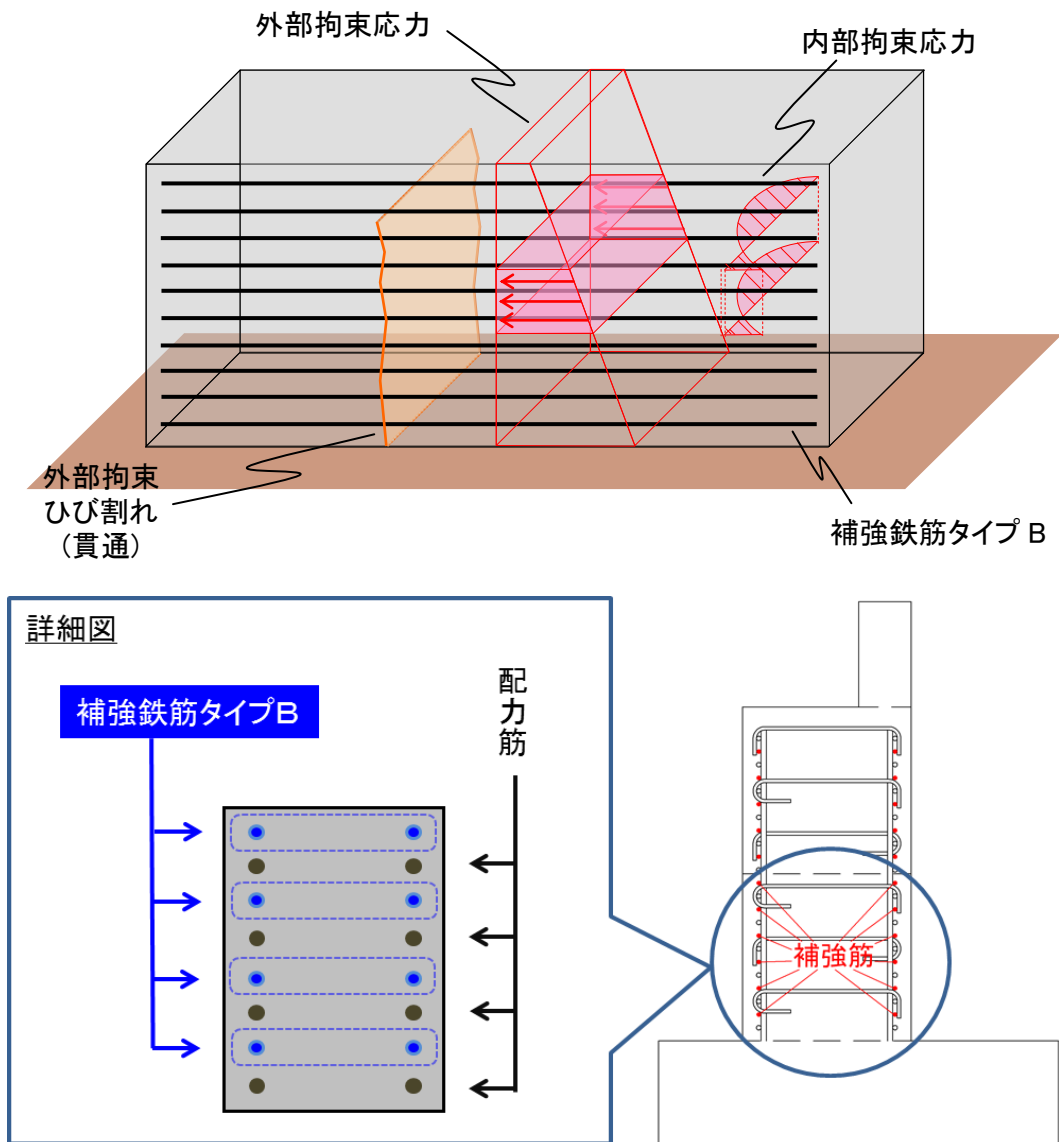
ひび割れ発生方向と抵抗鉄筋概要図（補強鉄筋タイプ B）
